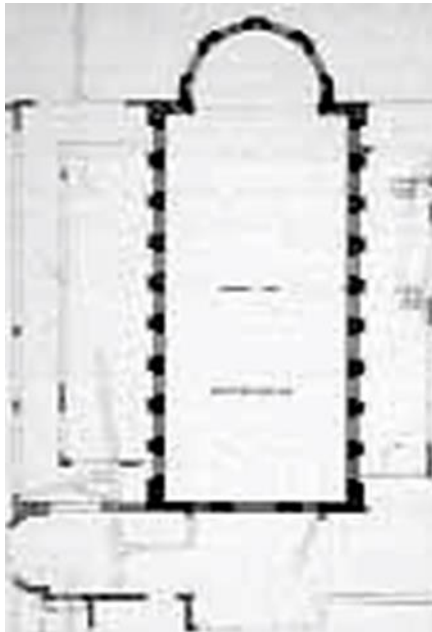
Abb. XXIX: Trier, Palastaula; errichtet unter Konstantin, Trier, Palastaula; Grundriss
